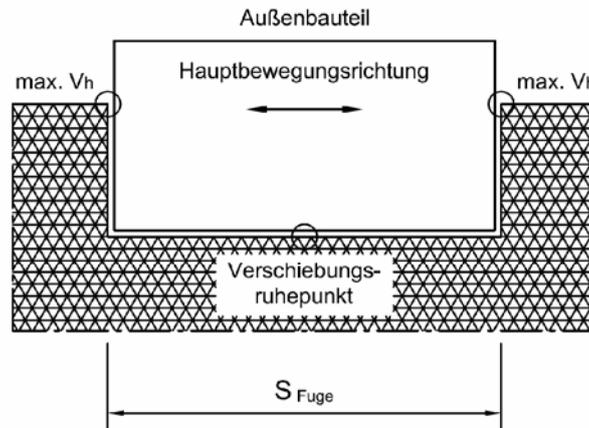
Einbausituation mit Lagerung an gegenüberliegenden Rändern
